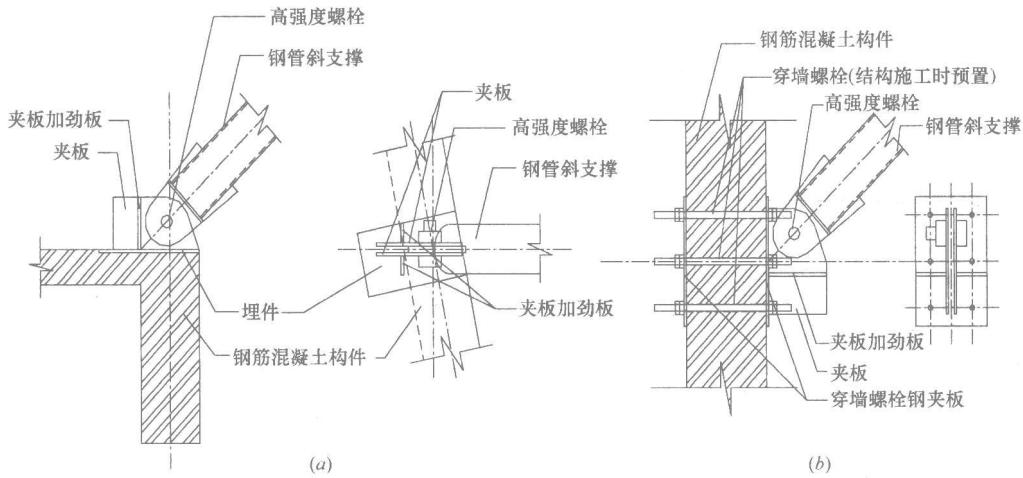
钢管斜撑与钢筋混凝土支座节点构造示意
